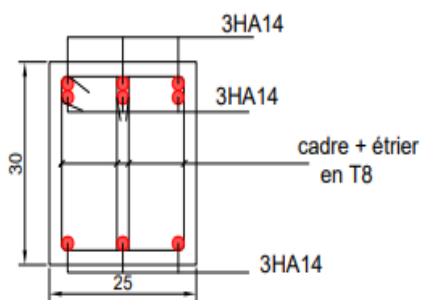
Ferrailage des poutres secondaires (Zone1)
